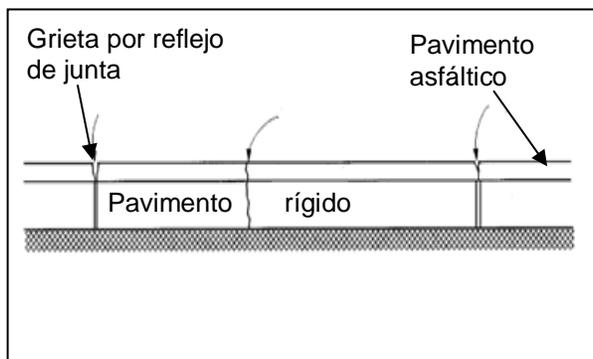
Grieta por reflexión de juntas (Autor,2012)
